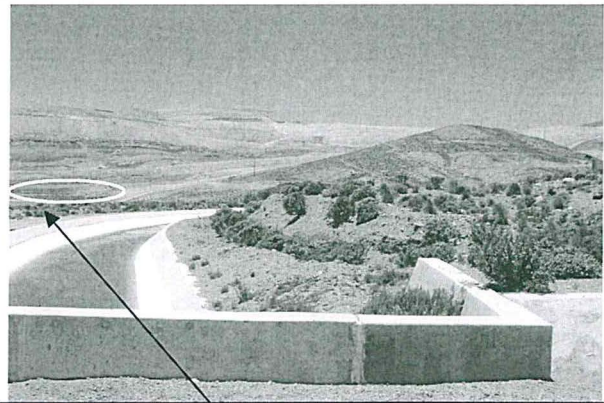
UBICACIÓN DEL PAD DE LIXIVIACIÓN A LA LADO IZQUIERDO DEL CANAL UCHUSUMA
